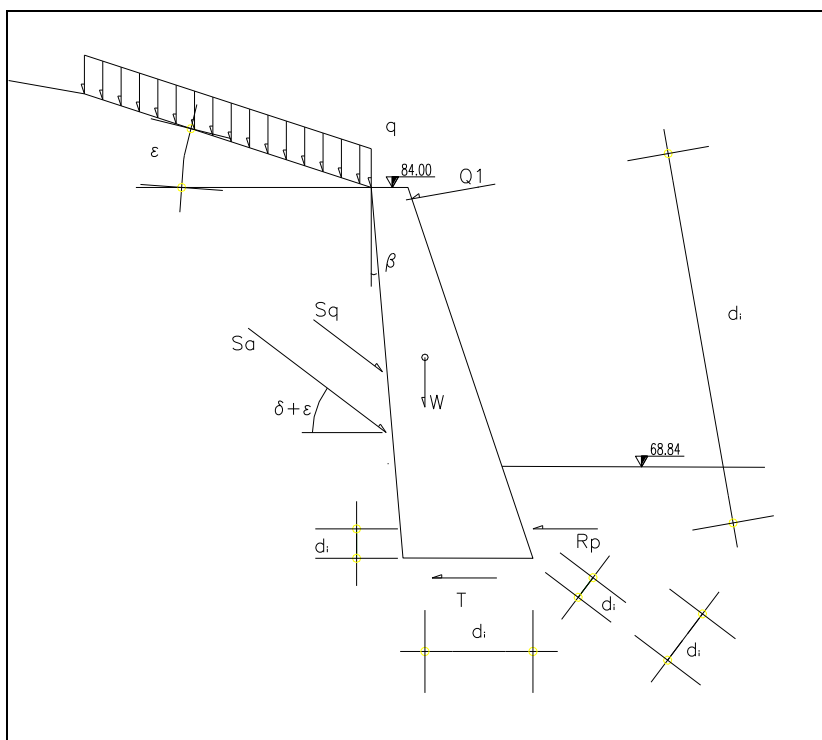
Schema delle forze e dei bracci rispetto allo spigolo esterno della fondazione – Caso statico
